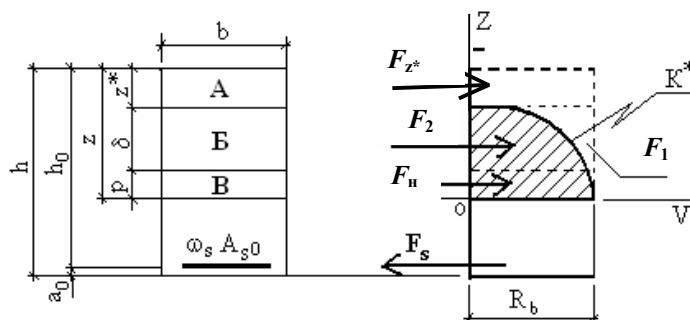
Схема напряженного состояния нормального поперечного сечения поврежденного коррозией изгибаемого железобетонного бруса с единичным армированием
